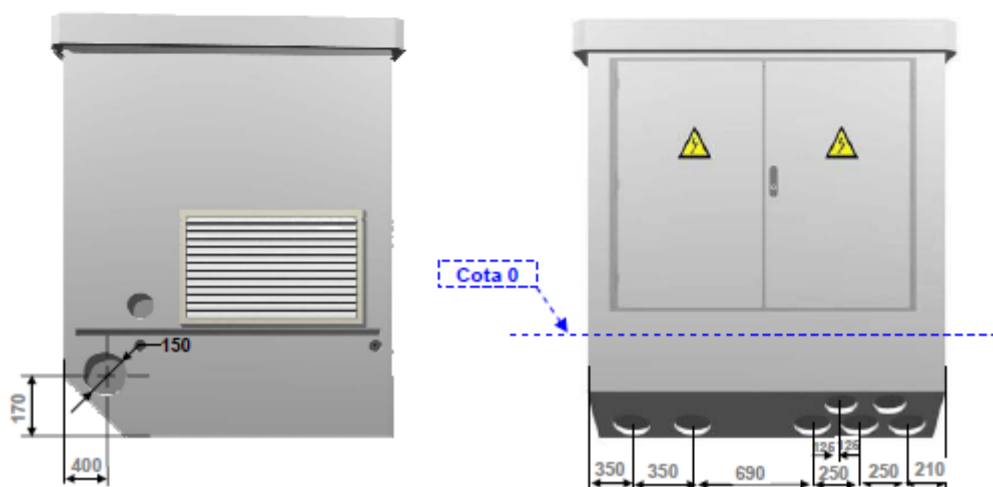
Dimensiones de los accesos de cable de MT / BT
